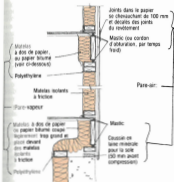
INTERSECTION ENTRE LE MUR EXTÉRIEUR ET LE PLANCHER
